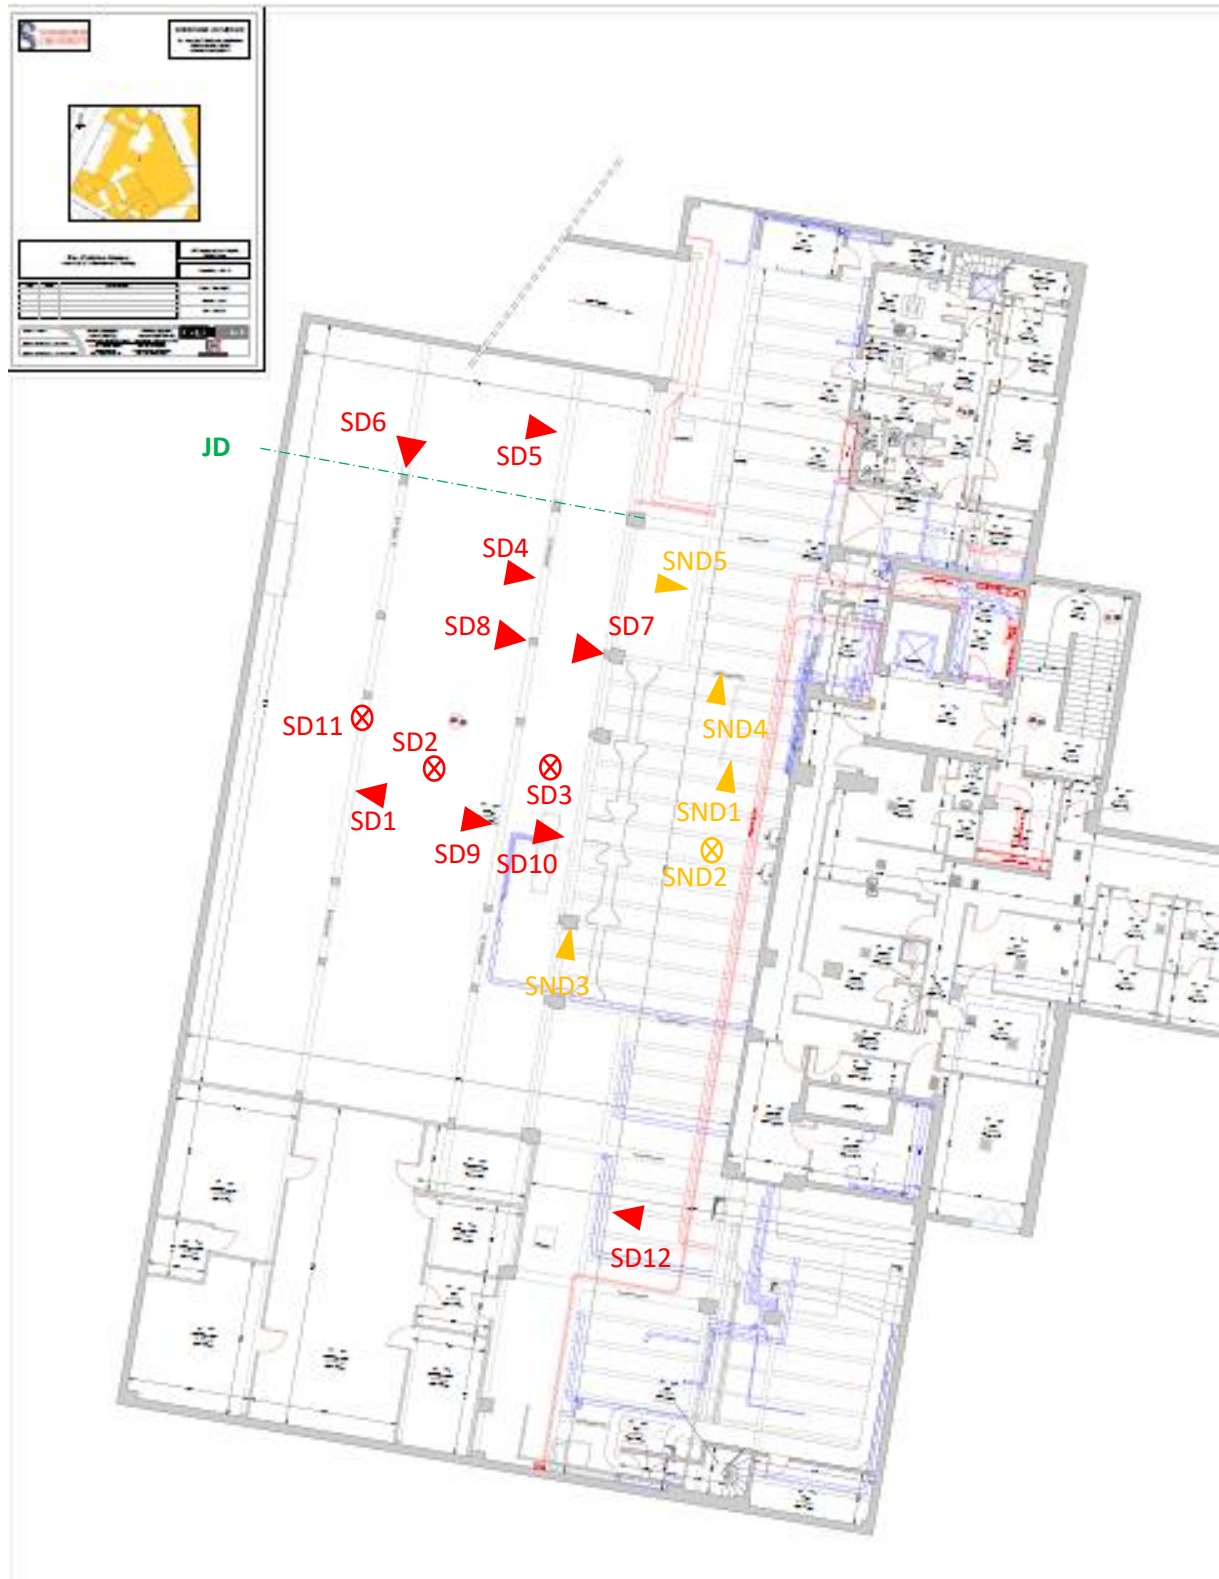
Implantation des sondages destructifs et non destructifs au niveau du plancher haut SS
